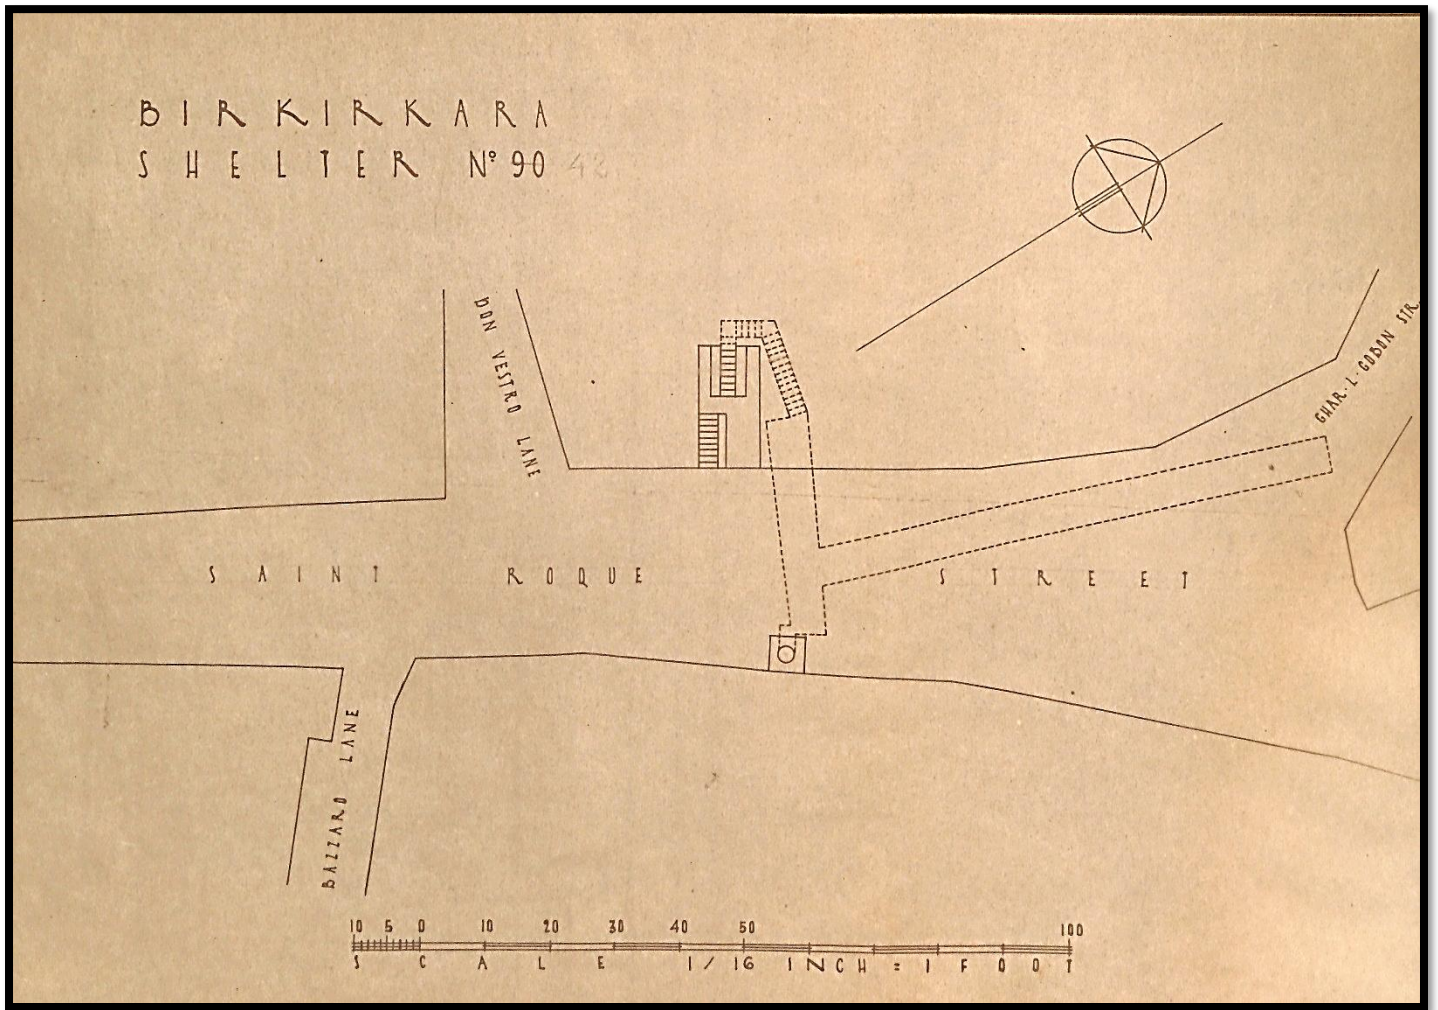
Planta do Abrigo nº 90 (42) "Saint Roque Street"
